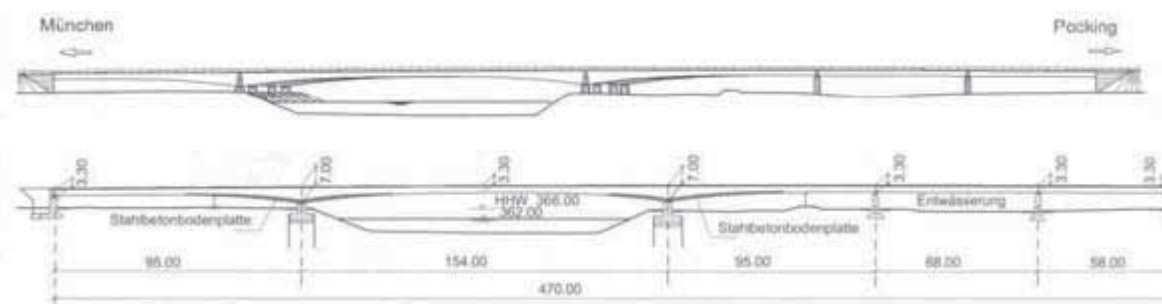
Elévation et coupe longitudinale du pont de Neuötting sur la rivière Inn, Allemagne, 2000.
